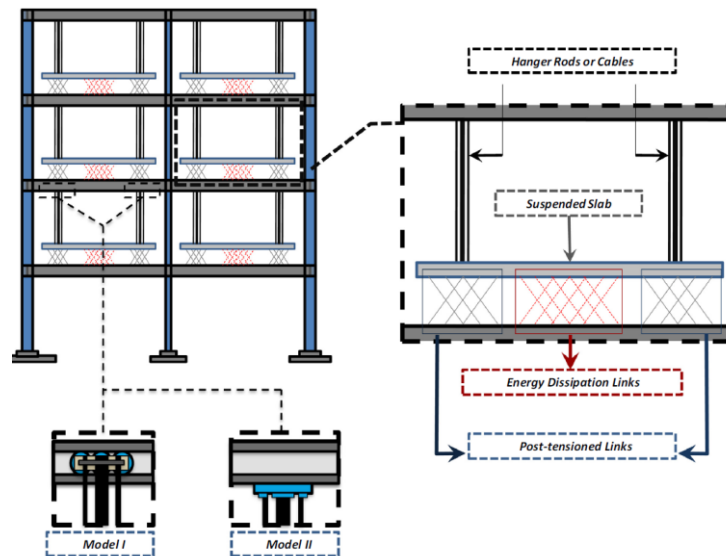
Схема здания с подвешенными плитами перекрытий
